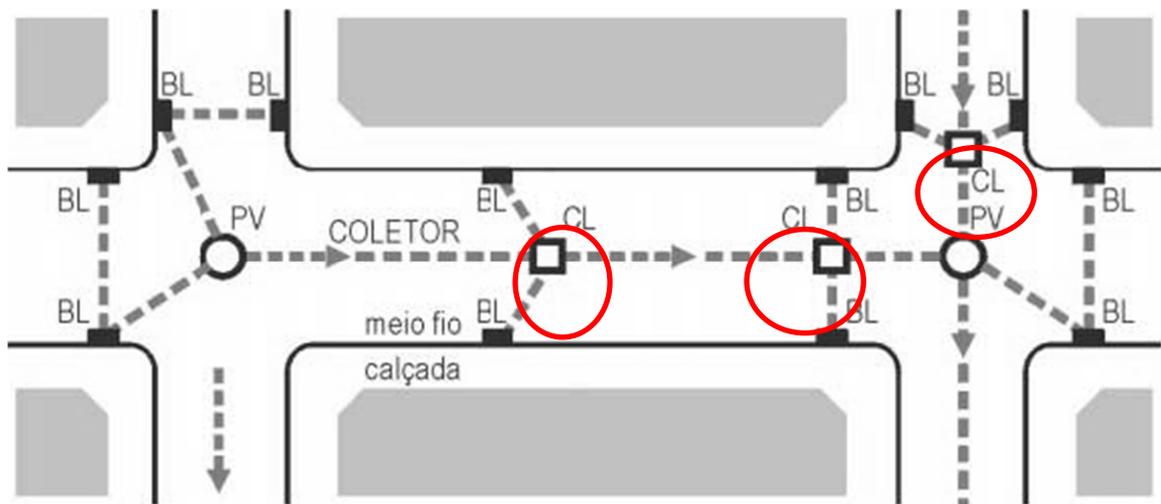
Locações das caixas de ligação em destaque (FONTE: SUDERHSA [6])
